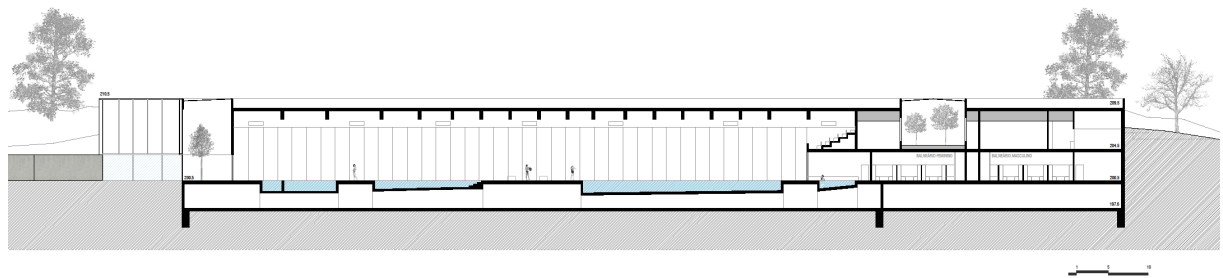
Proposta: Corte Longitudinal Piscinas, Fonte: Autor
